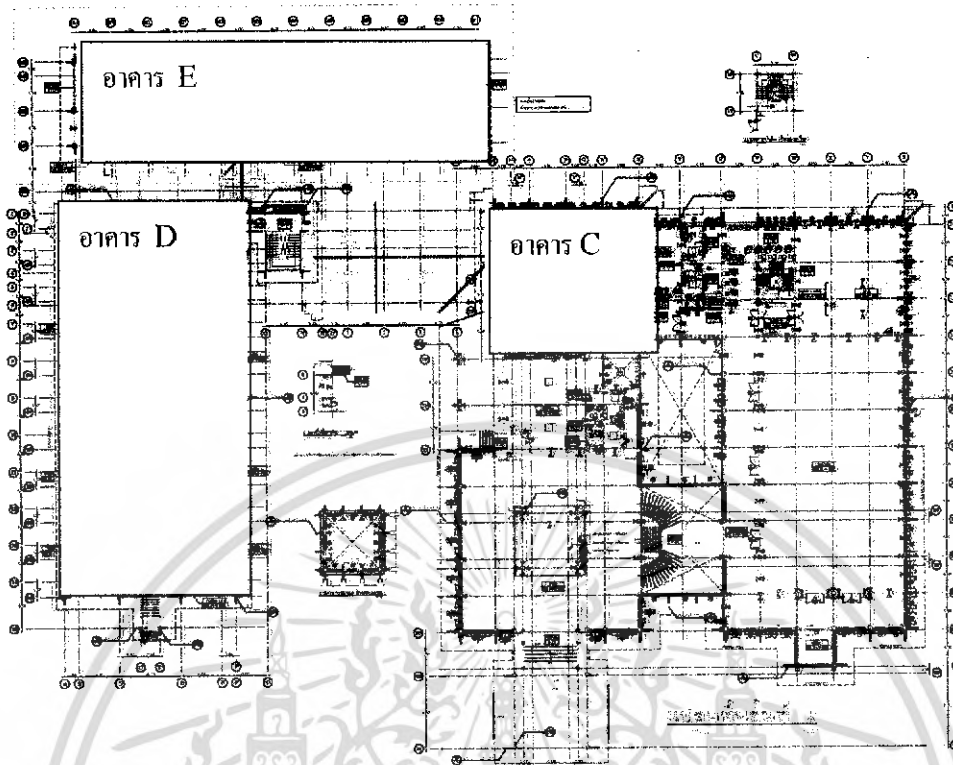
แสดง PLAN อาคาร A,B
